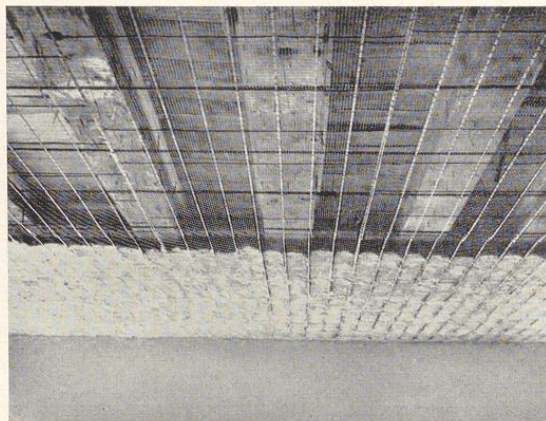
Rabitzdecke mit Baustahlmatten unter Holzgebälk, teilweise mit Gipshaarkalkmörtel ausgedrückt
